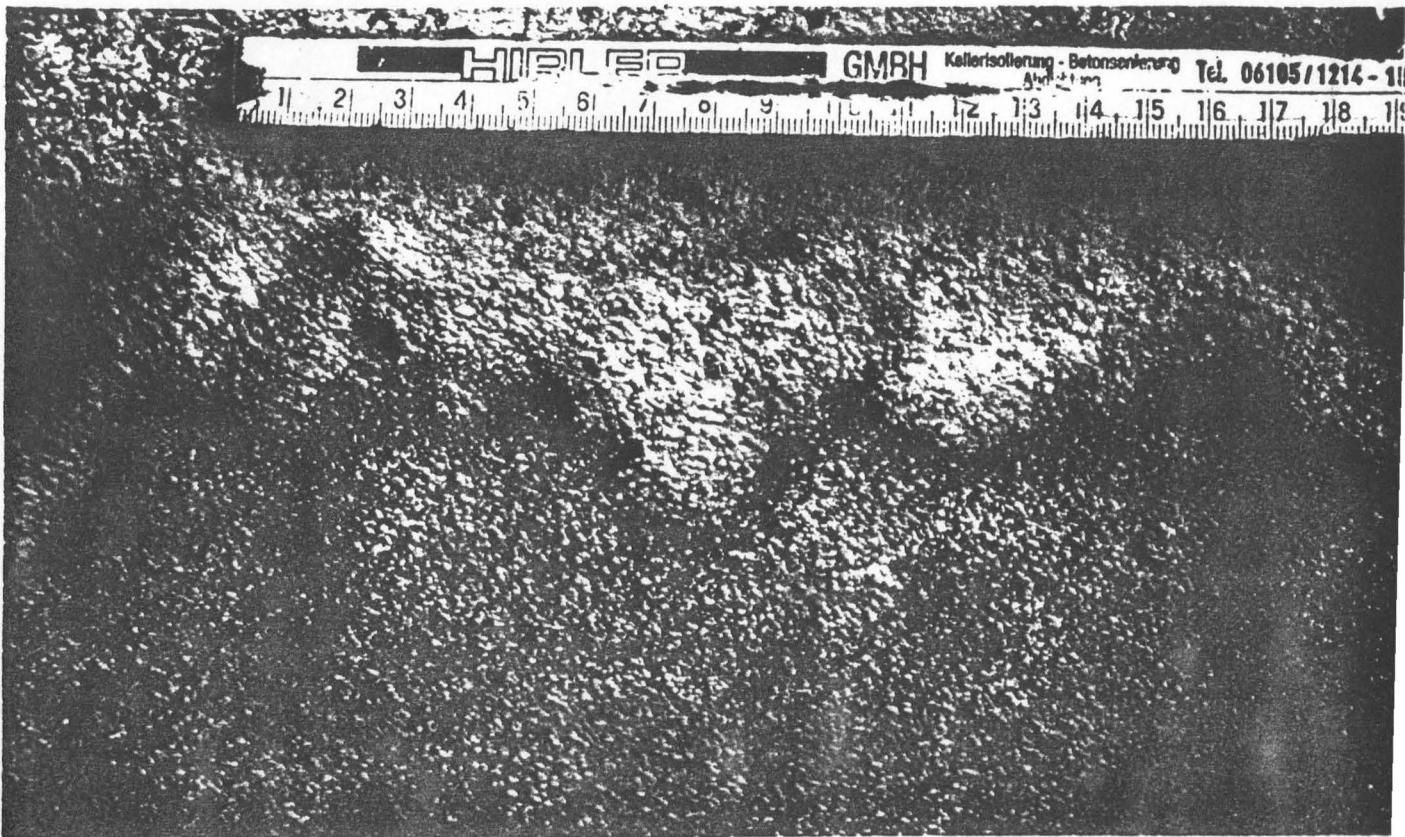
Details aus Abb. 49, Risse über den Bewehrungsstählen
